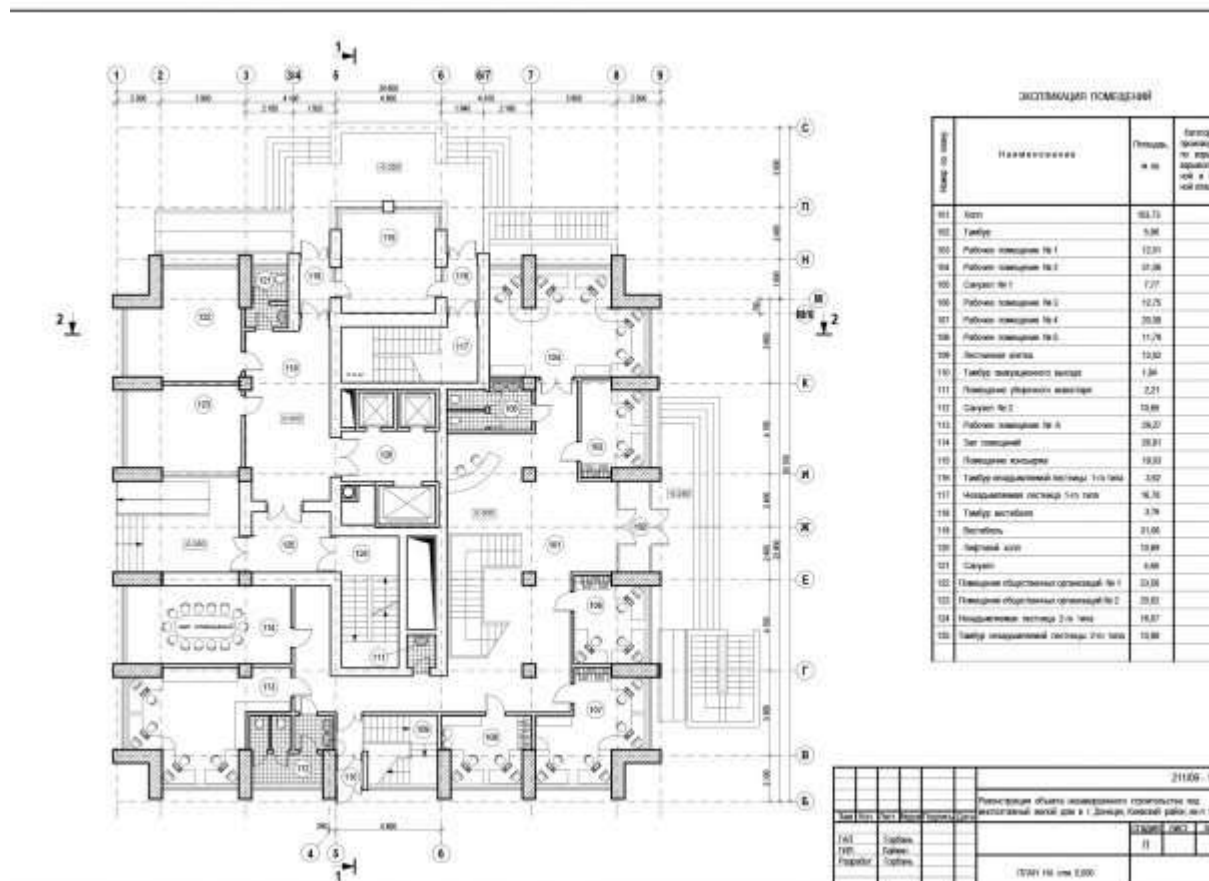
План першого поверху багатоповерхового житлового будинку, м. Донецьк, проектування 2001–2003 рр. Архітектори Олена Горбань, Олександр Горбань [13]
